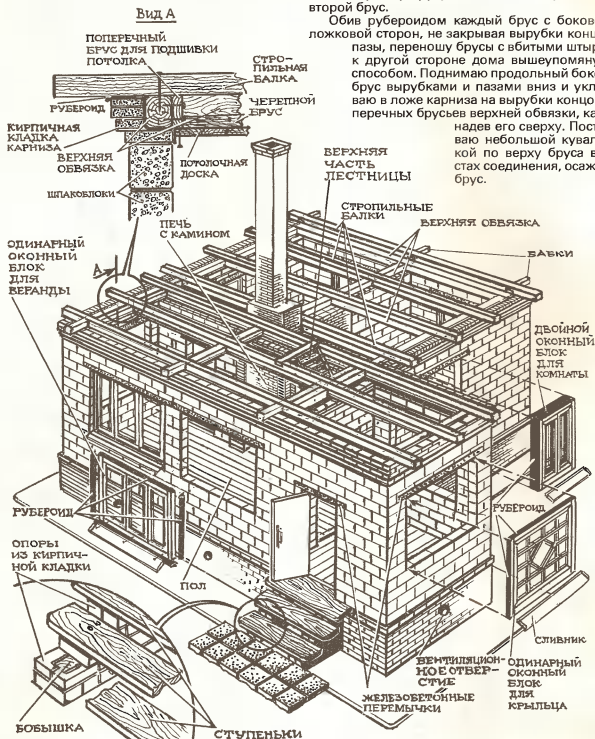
Укладка верхней обвязки, стропильных балок и изготовлении наружной лестницы.
